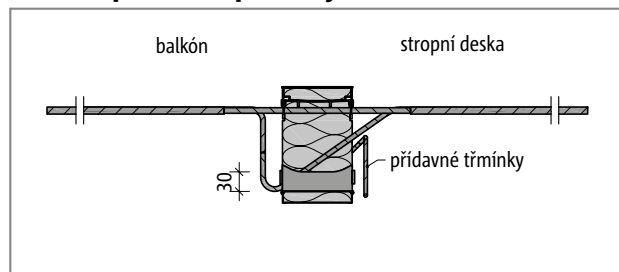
Schöck Isokorb® typ KXT15 až KXT40: Řez prvkem
